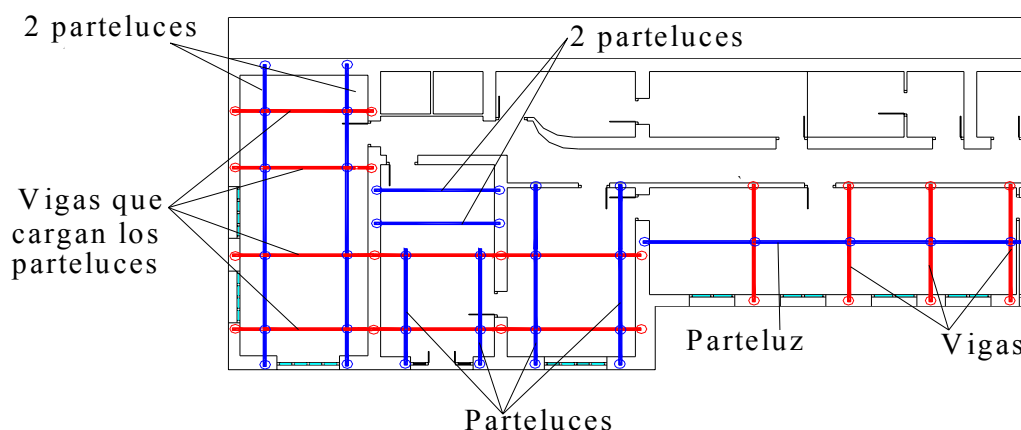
Planta parcial de los refuerzos de un forjado que no satisfacía la normativa de estructuras, a base de “parteluces” y “vigas cargadero” sobre muros de carga.
